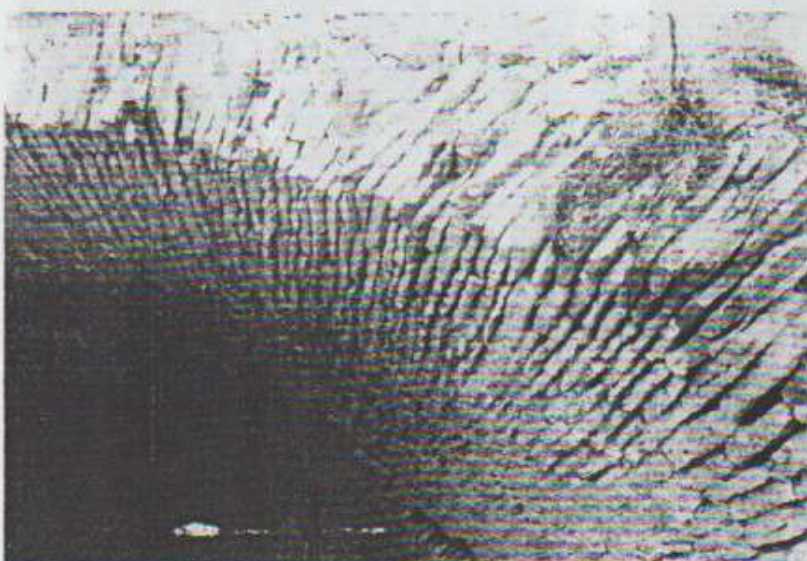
Voûte en calcaire lithographique (Salle du rez-de-chaussée de la tour de l'est)
